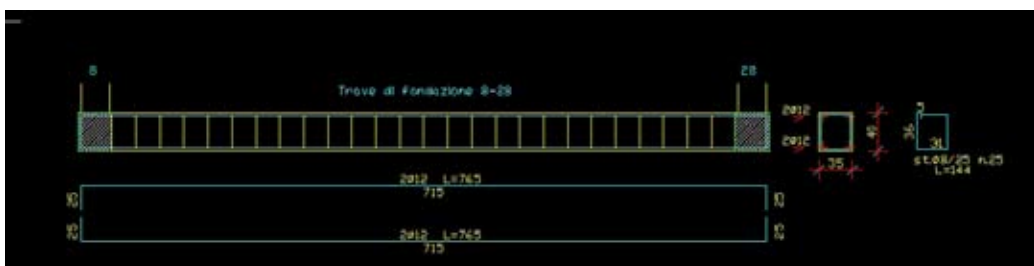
Armatura longitudinale e sezione corrente della soluzione con muratura portante.
